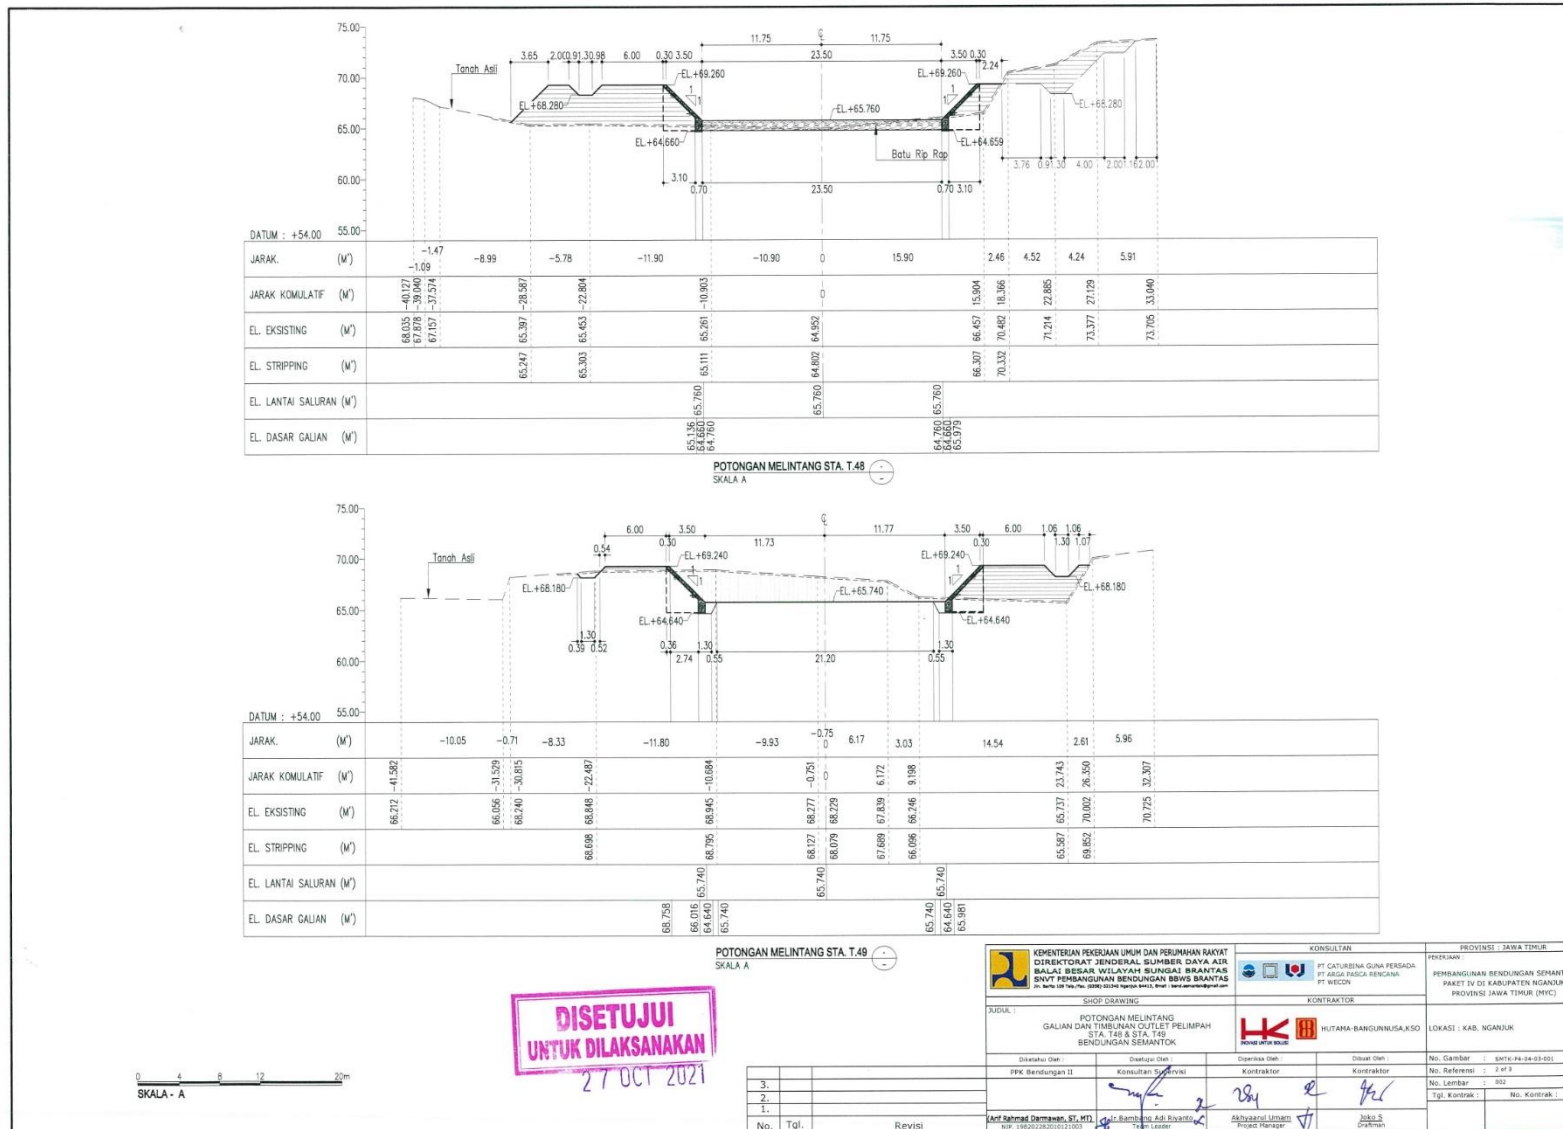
Layout Outlet Pengelak dan Outlet Spillway
